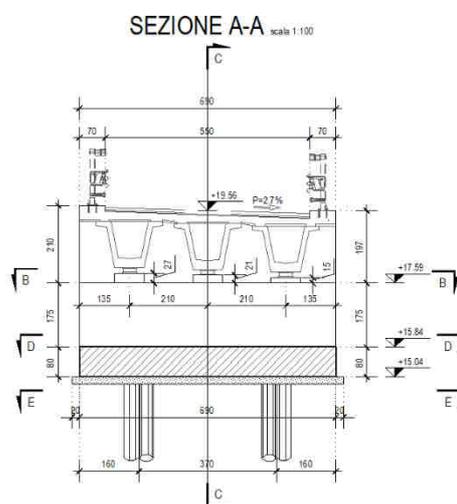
Spalla A prospetto – Ponte Rio Salius su viabilità AV04
